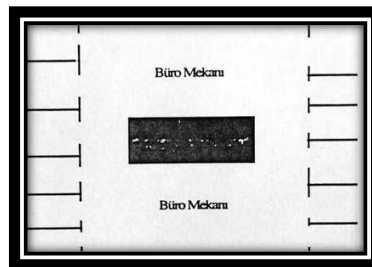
Açık planlı ofis plan tipi (Bal 2005)
